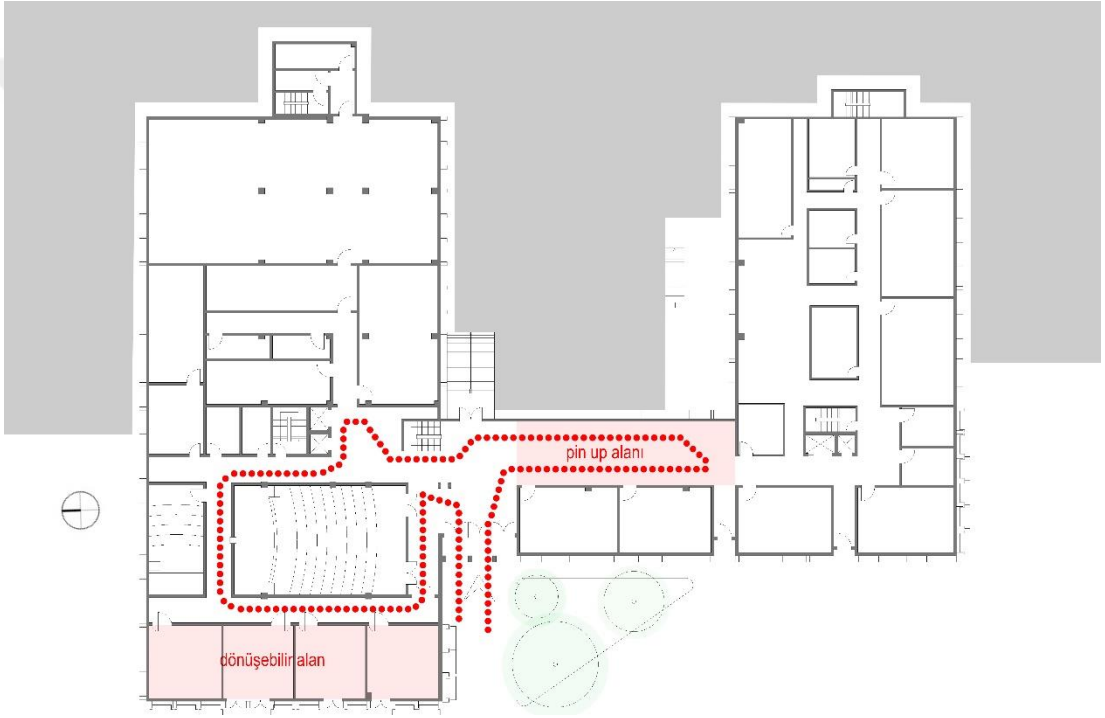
Wurster Hall Giriş Alanı (Pin Up Space) (CED Berkeley, 2018)
